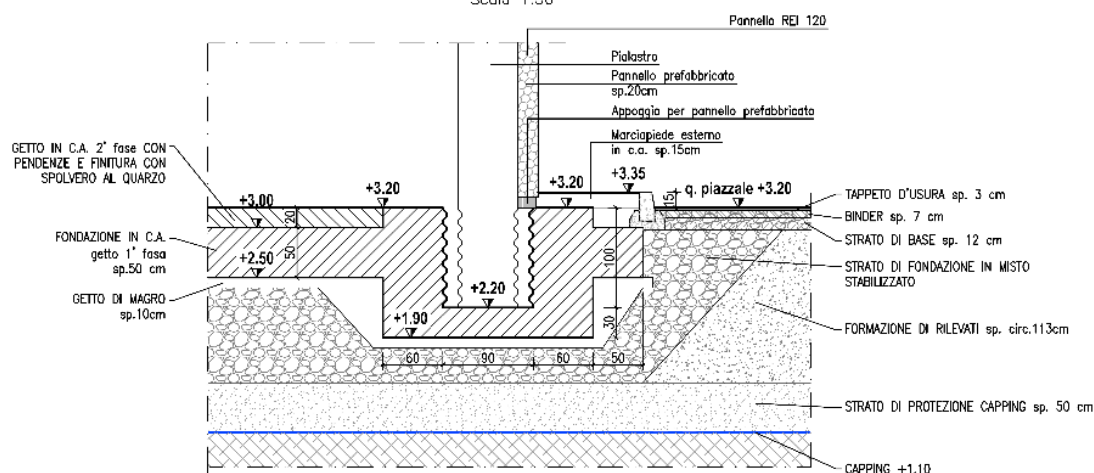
Sezione tipo della fondazione di un pilastro esterno
